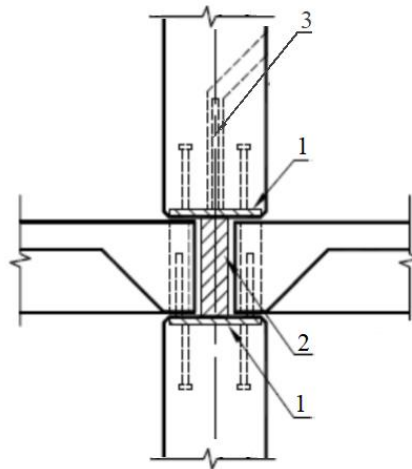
Узел соединения колонн с плитами перекрытия в системе «Bestcon30»
